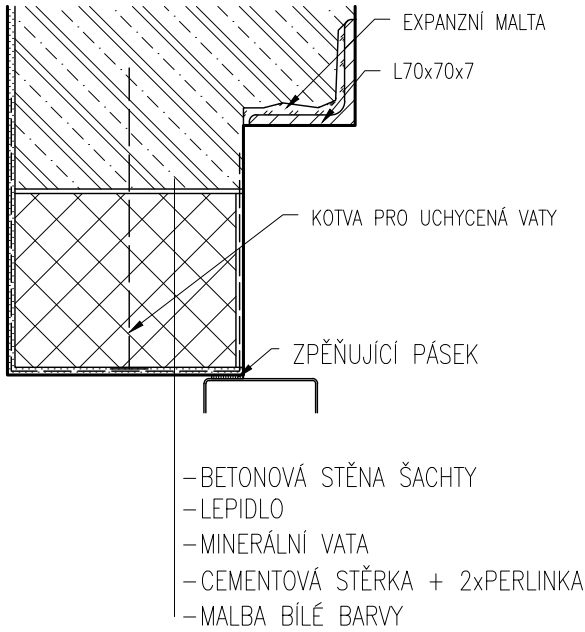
PRÁH ŠACHETNÍCH DVEŘÍ
